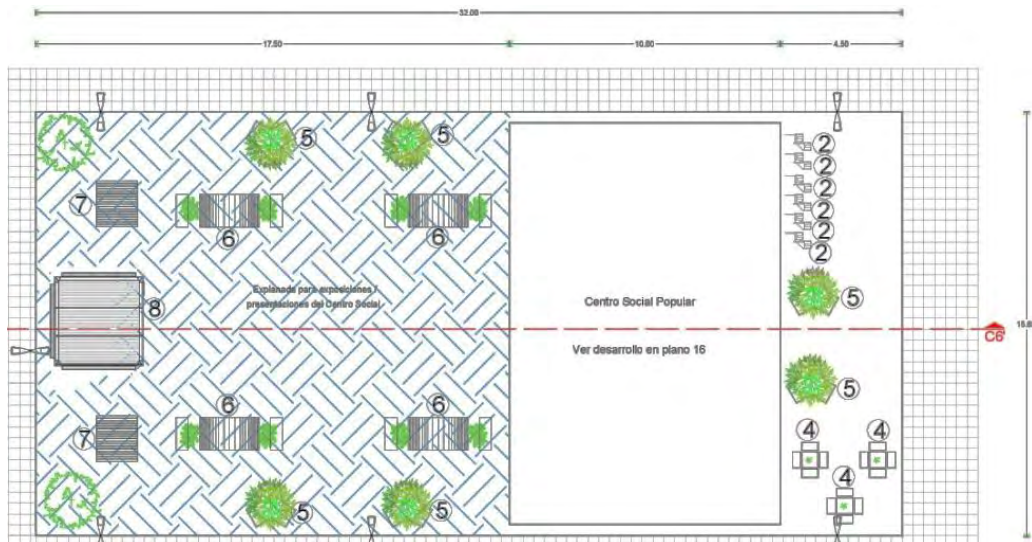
Planta arquitectónica de la plaza 7. Se muestra la distribución del mobiliario y los cambios de pavimento para ayudar a la configuración de la plaza.
